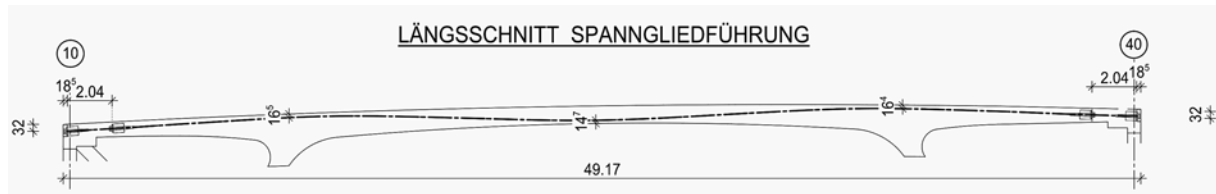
Spanngliedführung im Aufriss (Regellängsschnitt)
